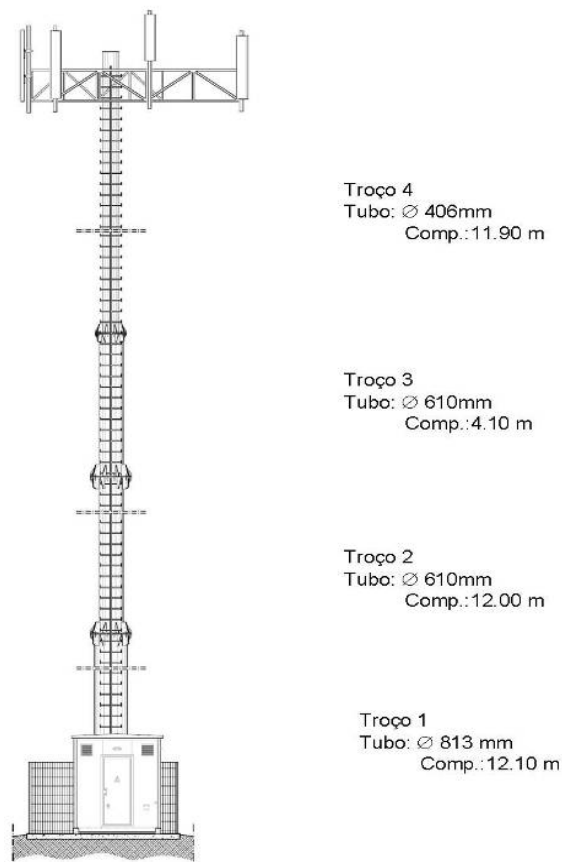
Poste Tubular Flangeado Auto-suportado
